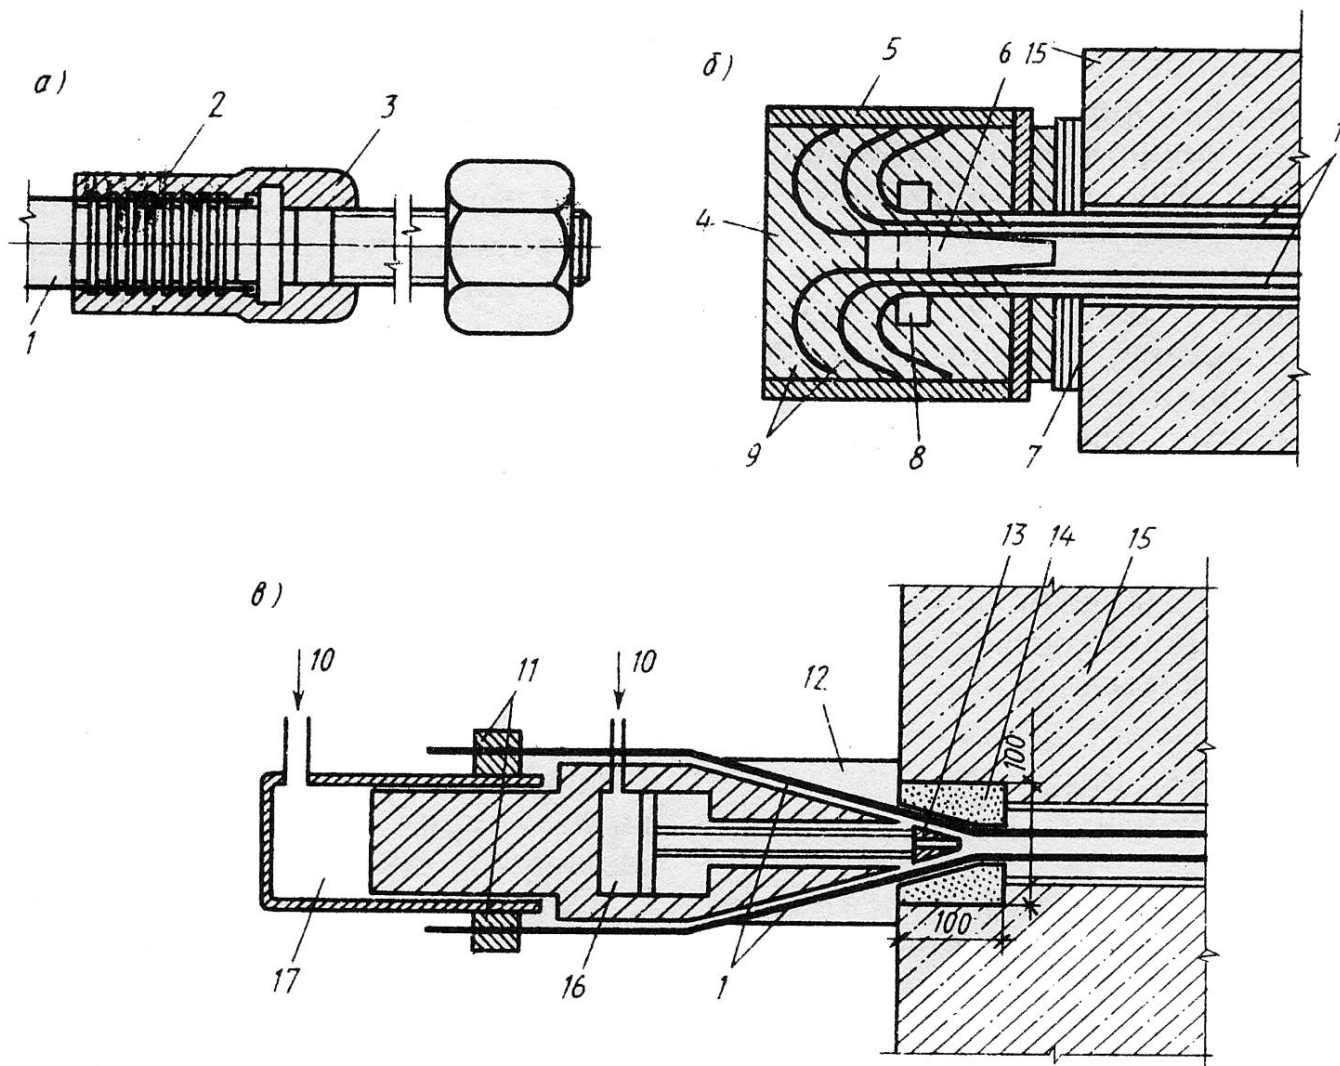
Анкеровка напрягаемой проволочной арматуры при натяжении на бетон:
